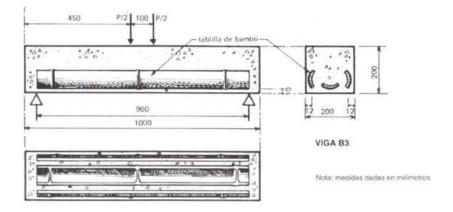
Viga (3) de hormigón reforzada con bambú. Fuente González Salcedo, 2001
